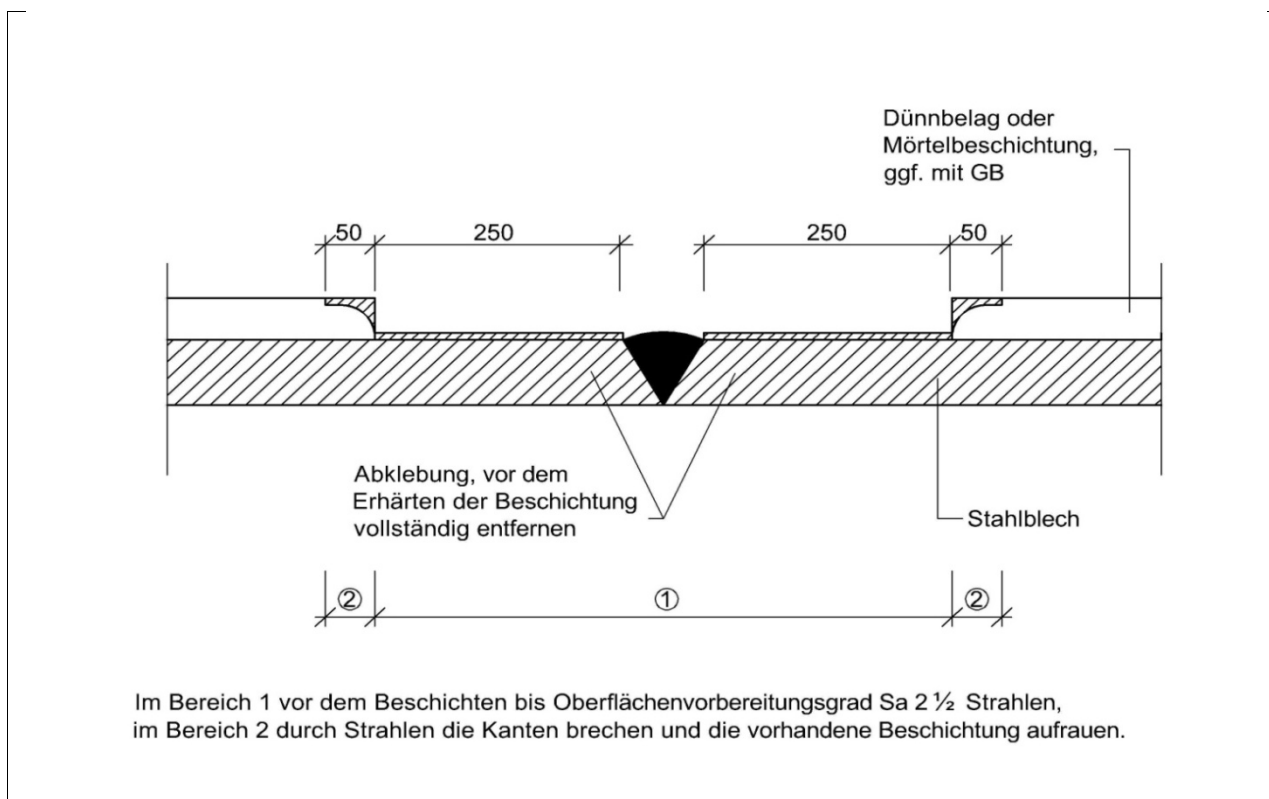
Gestaltung von Dünnelagen und Mörtelbeschichtungen im Bereich von Baustellenschweißstößen
